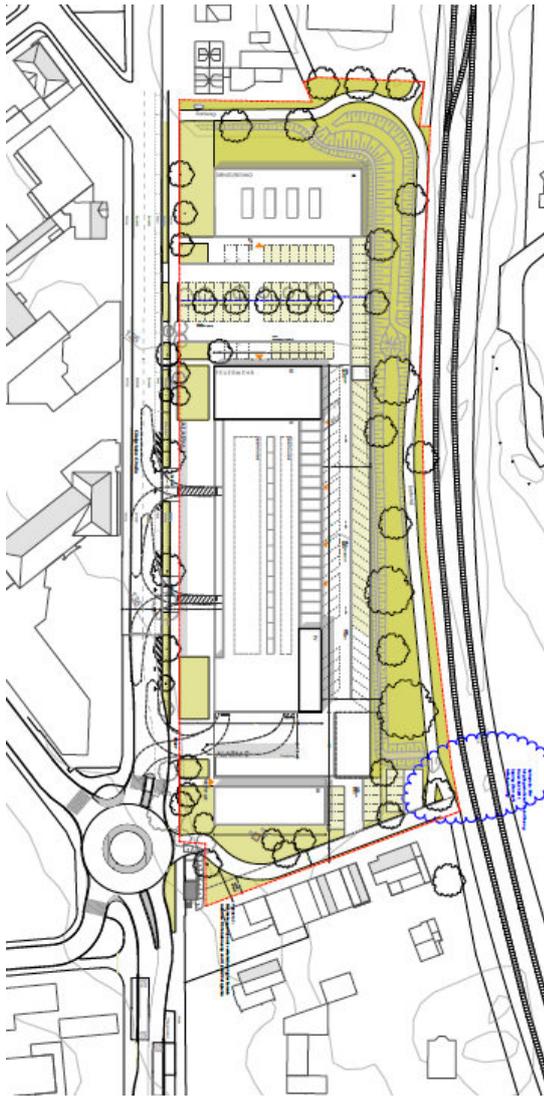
Lageplan mit Außenanlagen, Vorentwurf. Quelle: Jöllenbeck & Wolf Architekten
